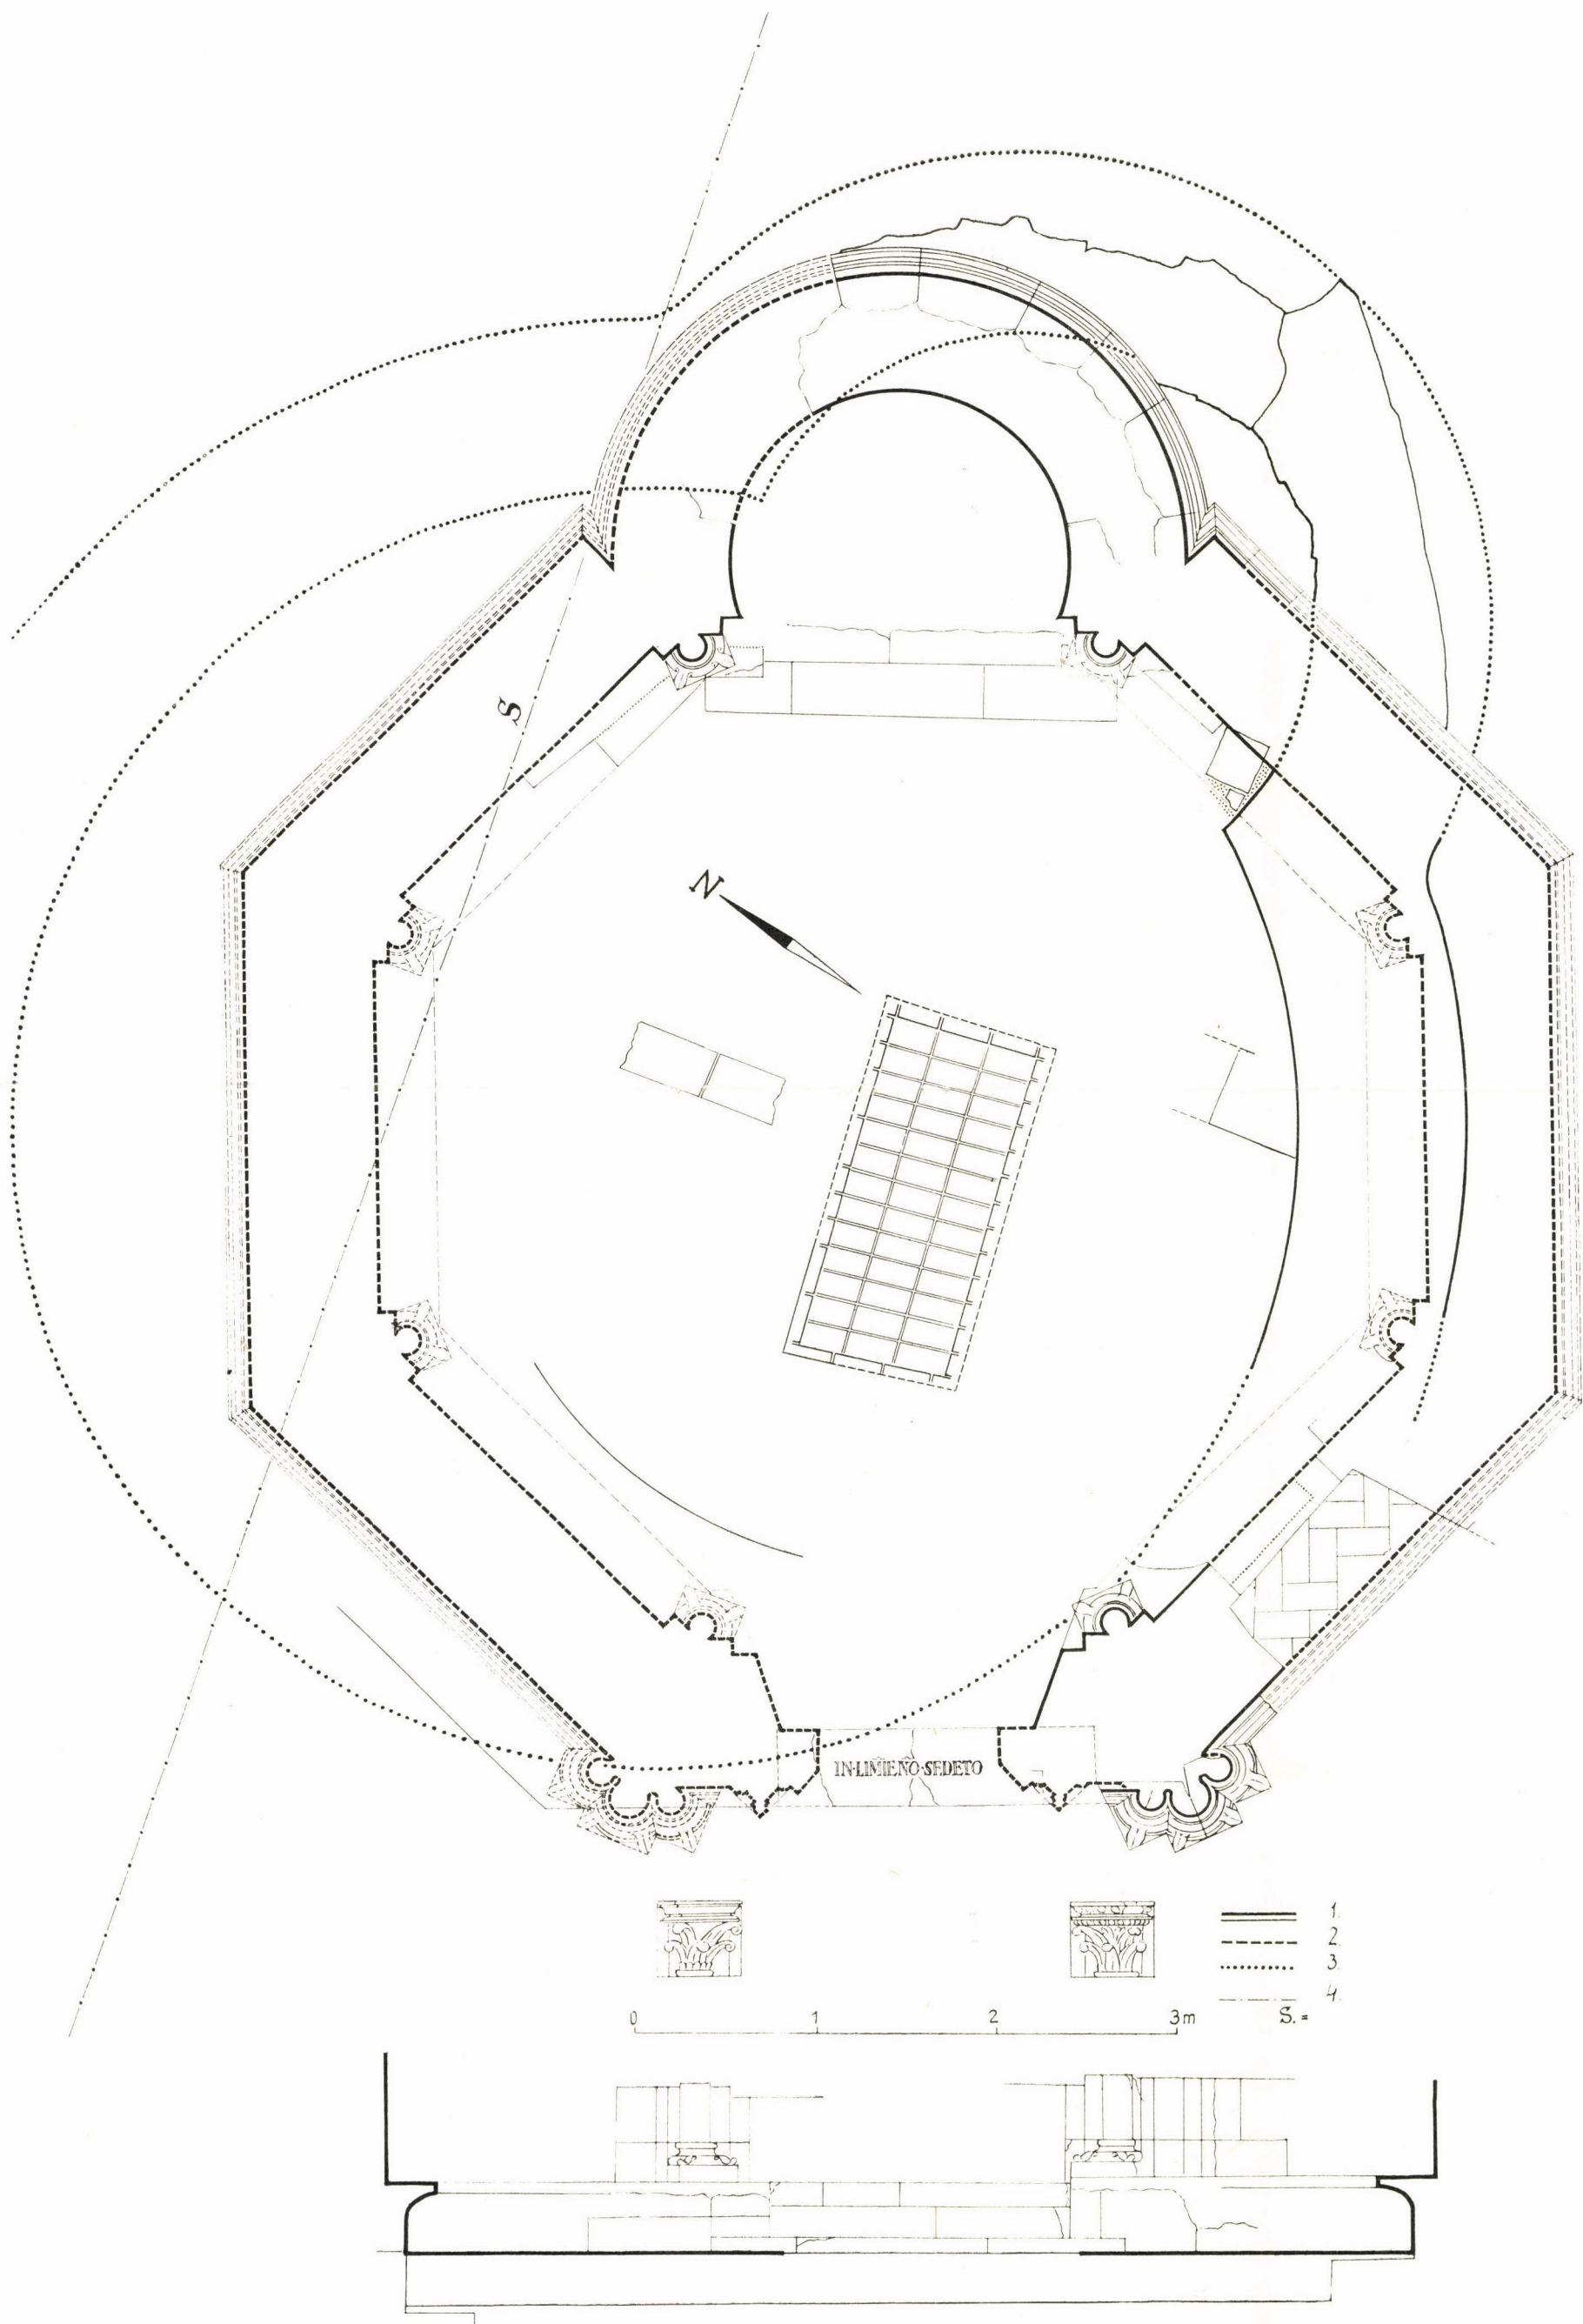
Rekonstruierter Grundriss und Schnitt der Rotunde und der oktogonalen Kapelle (Rekonstruktion von D. Várnai)
